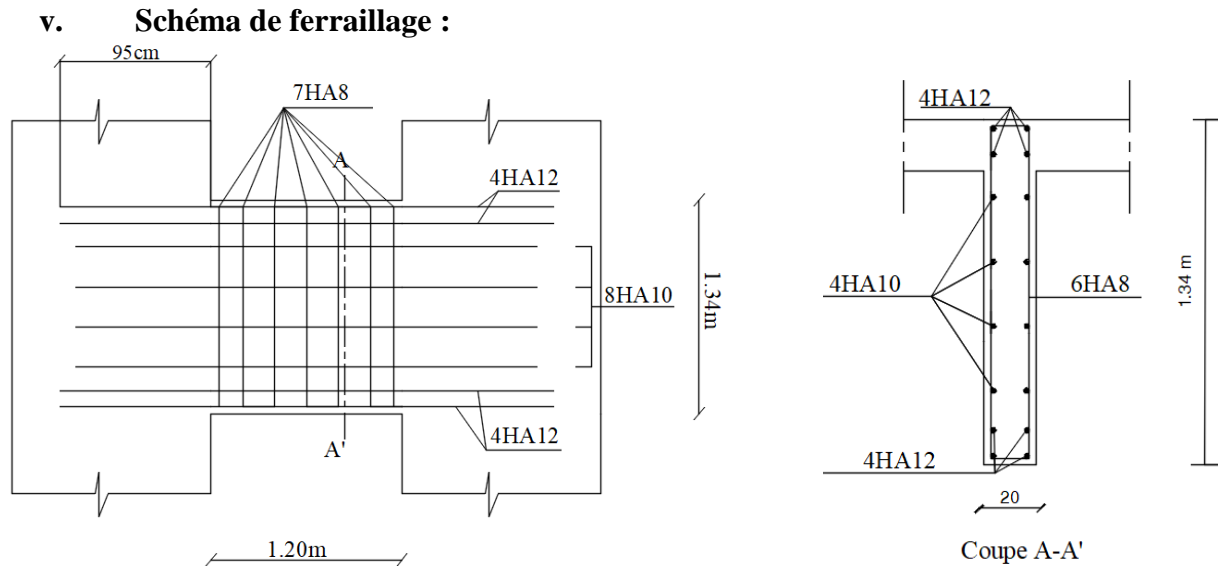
Schéma de ferrailage du linteau VL1 (RDC).
